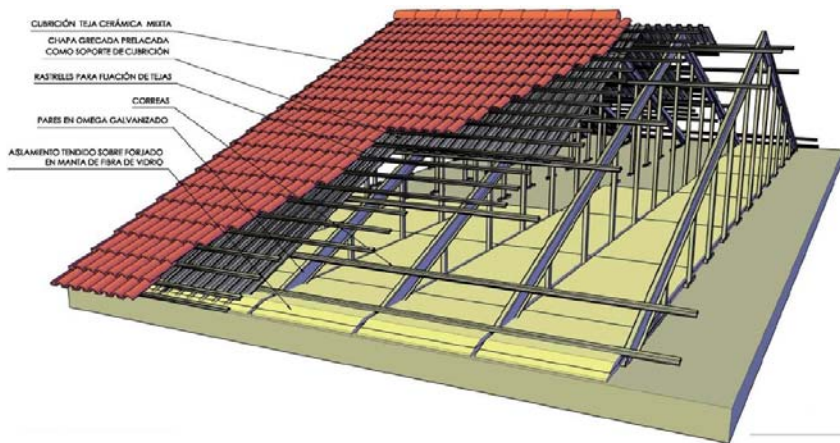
Cubierta de estructura metálica de omegas galvanizadas con chapa grecada y acabado en teja mixta. Fuente www.indelmadrid.com
